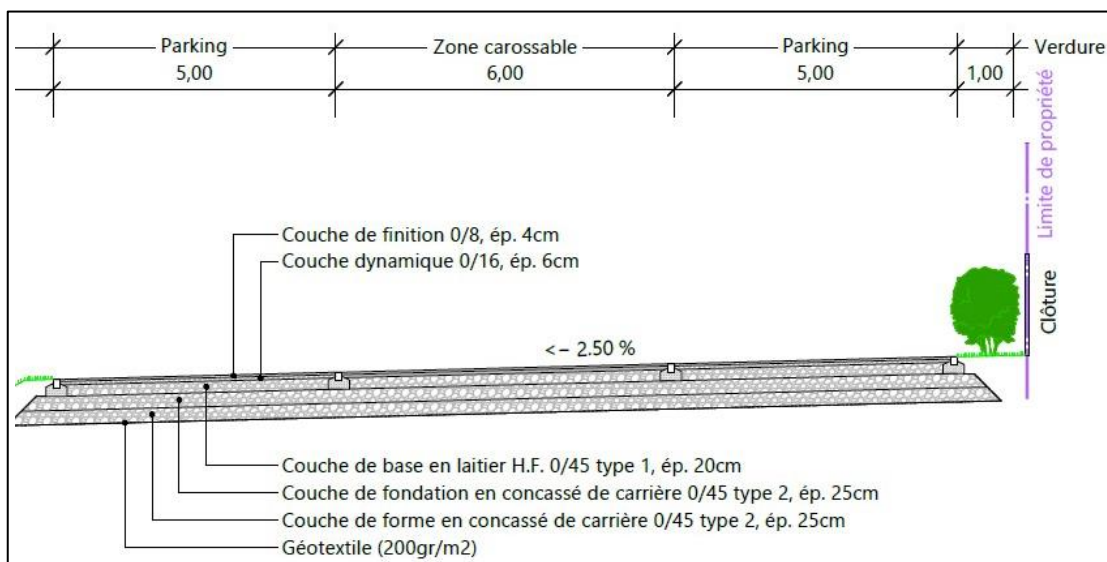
Extrait de la coupe relative aux couches planifiées du parking - zone « Emplacements ».
